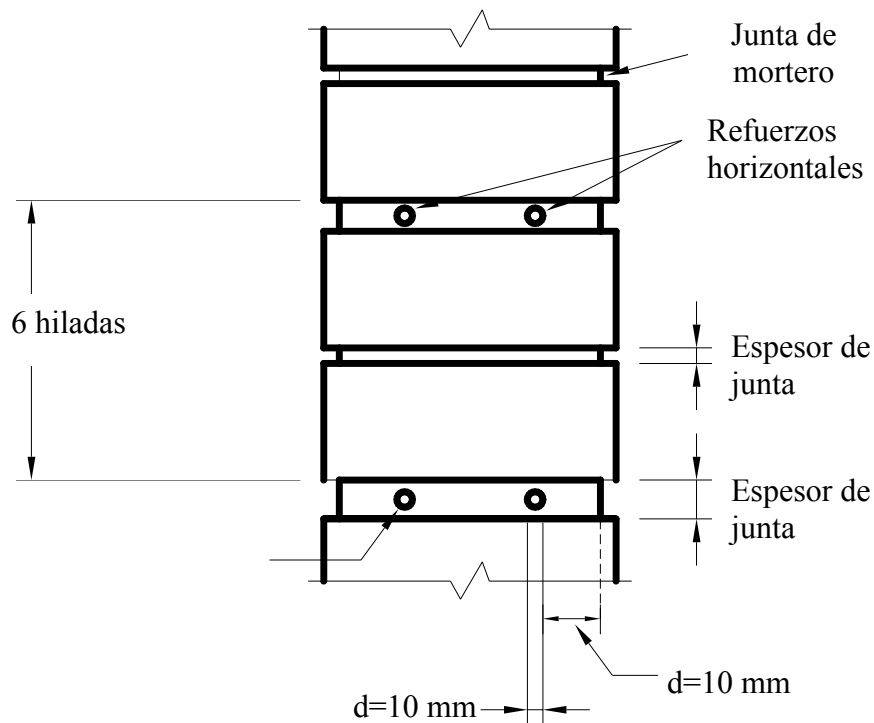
Acero de refuerzo en las hiladas de mampostería reforzada (RCDF, 2005).
